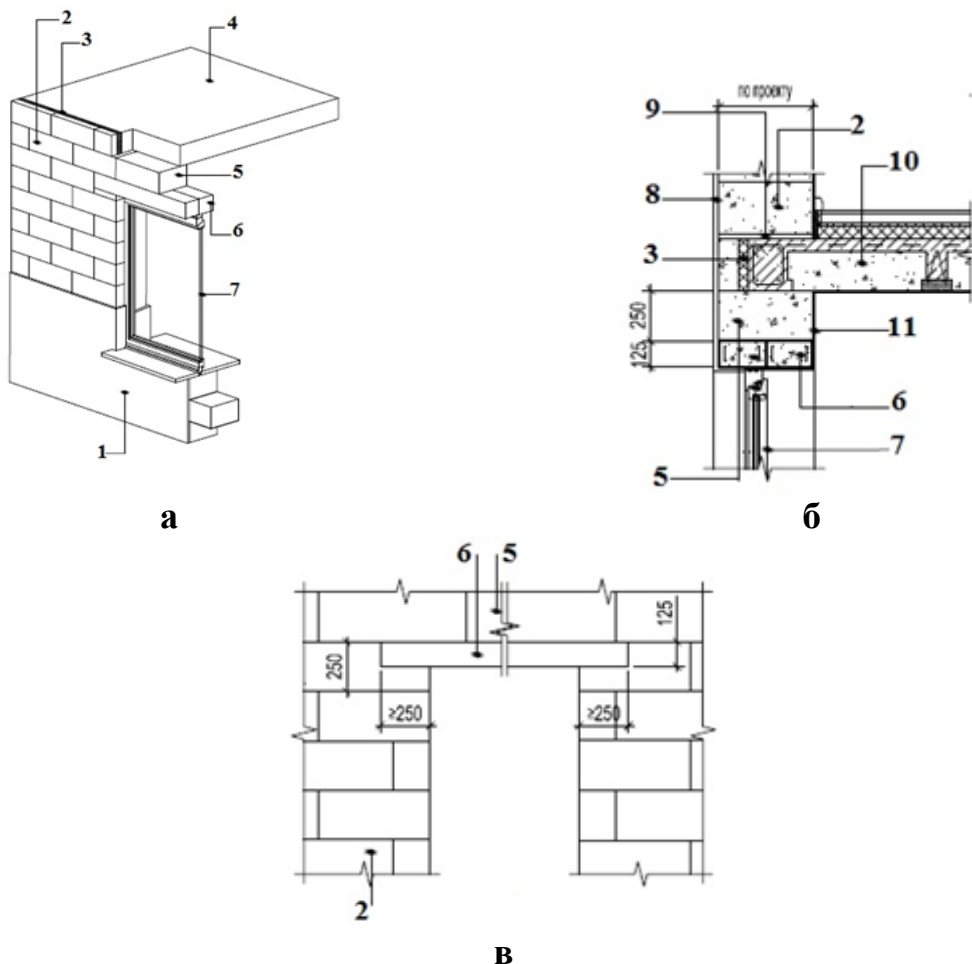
Деталь устройства системы YUTONG: а — элемент конструкции; б — разрез по стене; в — разрез по оконному проёму; 1 — наружная стена; 2 — блоки YUTONG; 3 — минеральная вата; 4 — перекрытие; 5 — гладкие блоки с наполненным вертикальным швом; 6 — газобетонная армированная перемычка; 7 — оконный блок; 8 — наружная отделка; 9 — шов из цементного раствора; 10 — сборное перекрытие; 11 — внутренняя отделка
